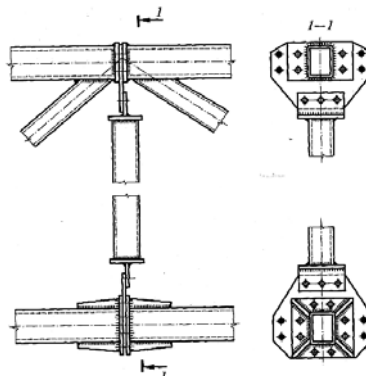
Укрепительный стык стропильной фермы из гнутосварных профилей на фланцах и высокопрочных болтах
